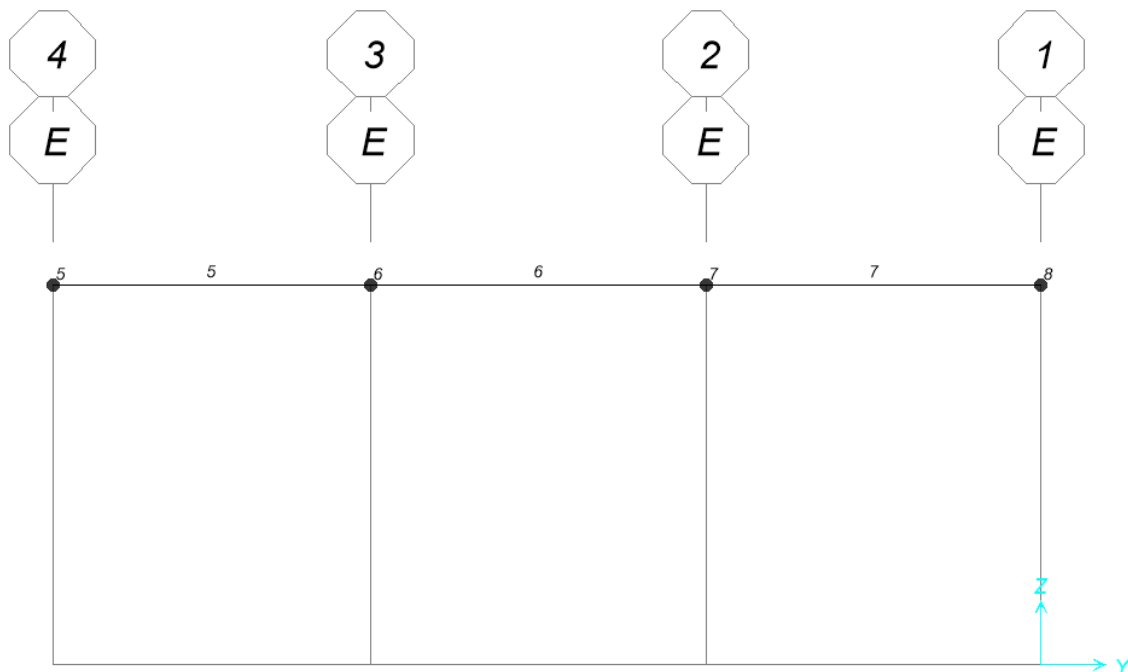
Vista in sezione modello struttura in elevazione –Filo E - numerazione elementi frame e joint
